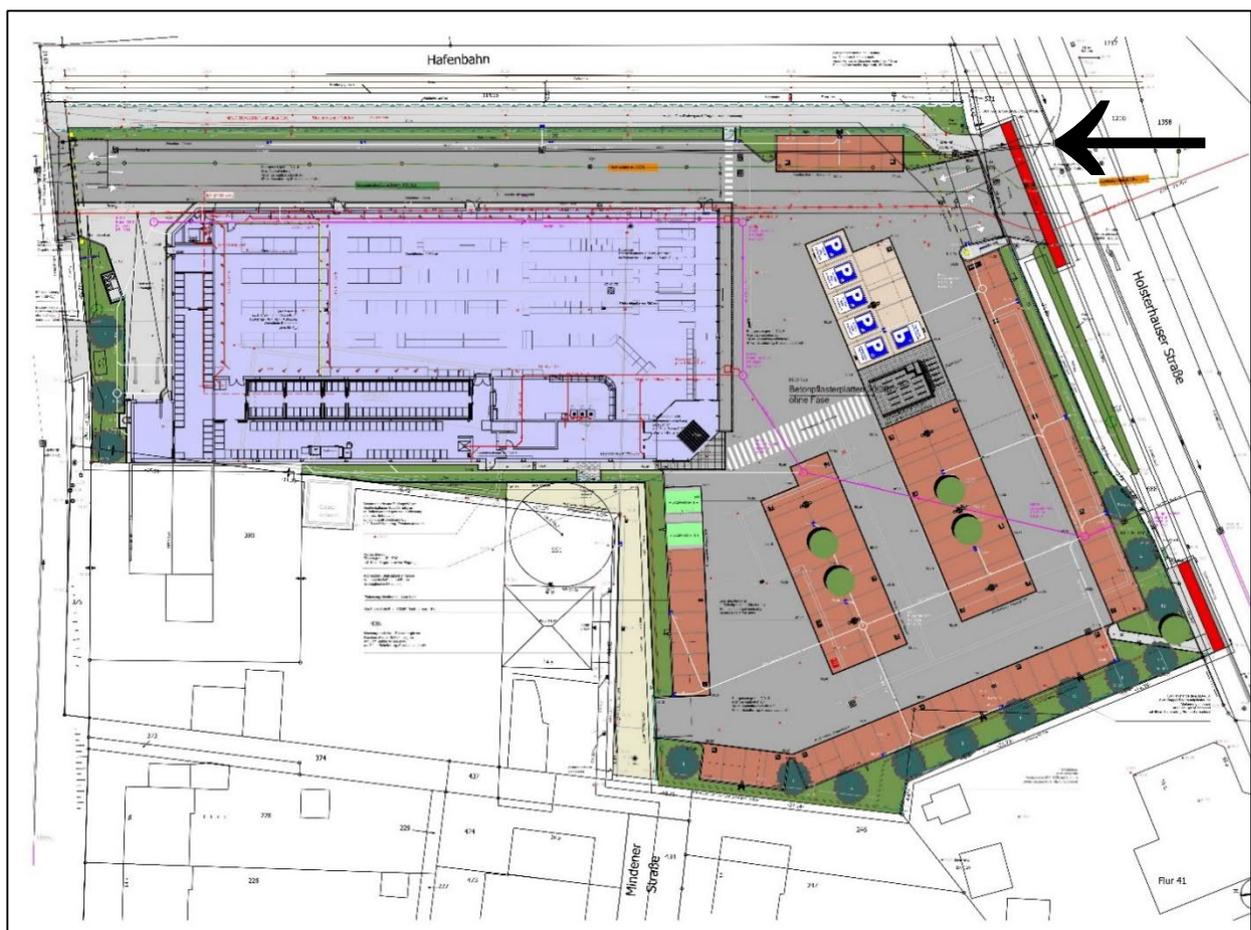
Lageplan Stand 25.10.2017 (Quelle: Grafen Bau GmbH, 2017)
